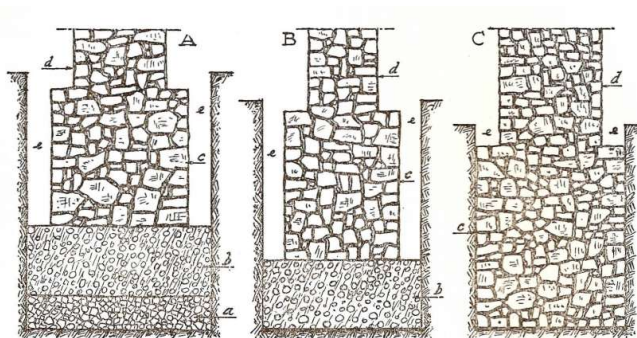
Diversos tipos de fundação: a) fundação com sapata de betão sobre cascalho; b) fundação com sapata de betão; c) fundação de alvenaria sobre terra (Costa, 1955).
